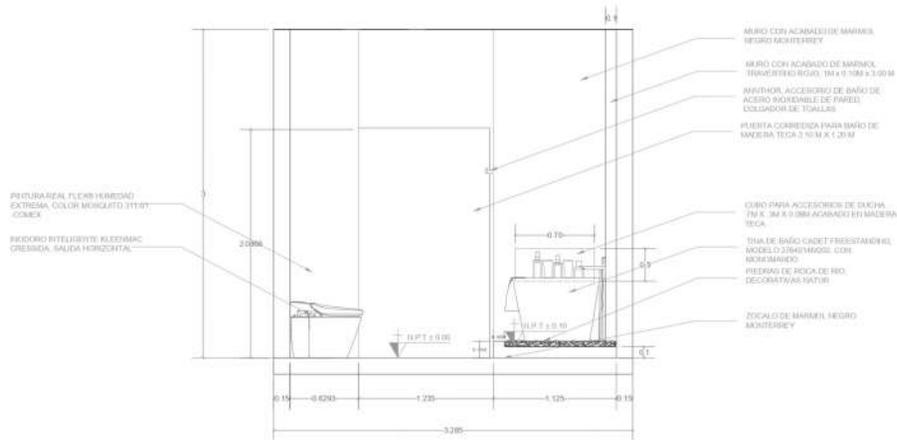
Detalles constructivos de baño. Elaboración propia , 2022
